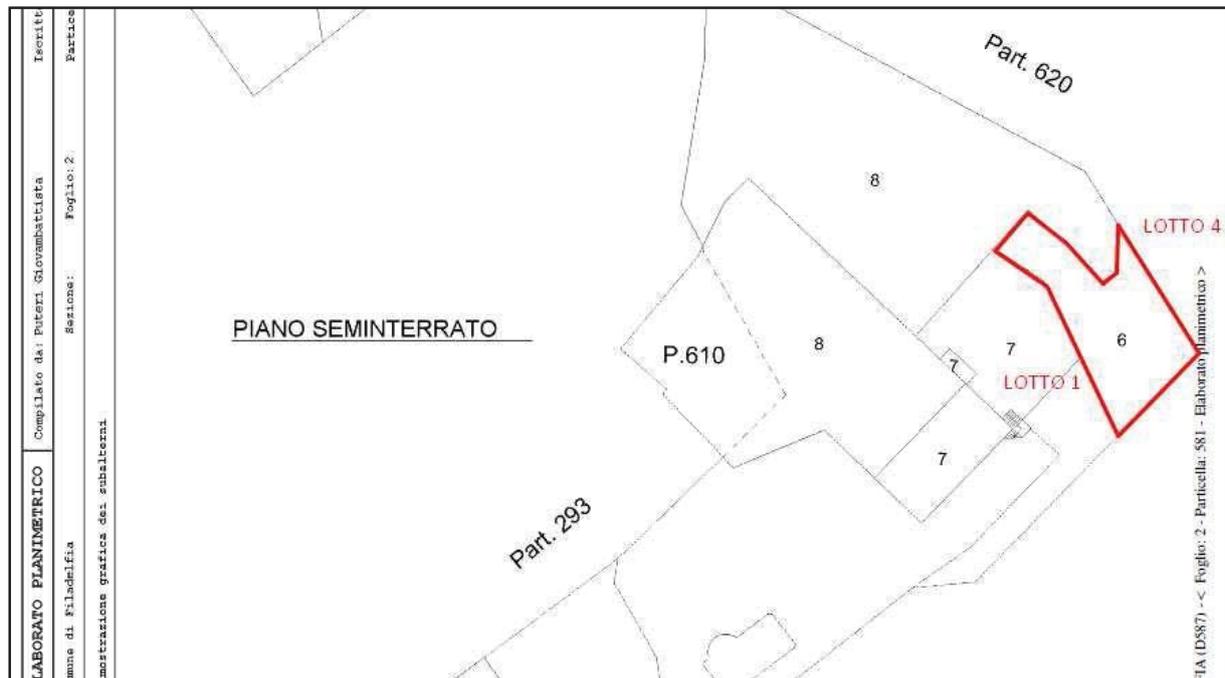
stralcio elaborato planimetrico part 581 piano seminterrato
